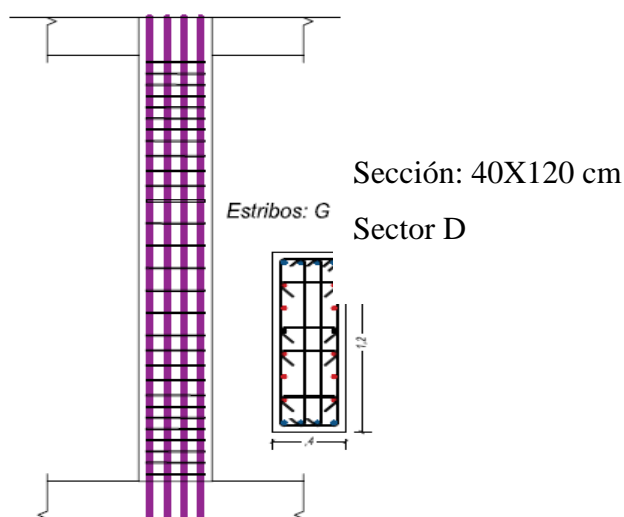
Detalle de Columna en Base Aislada (G)
